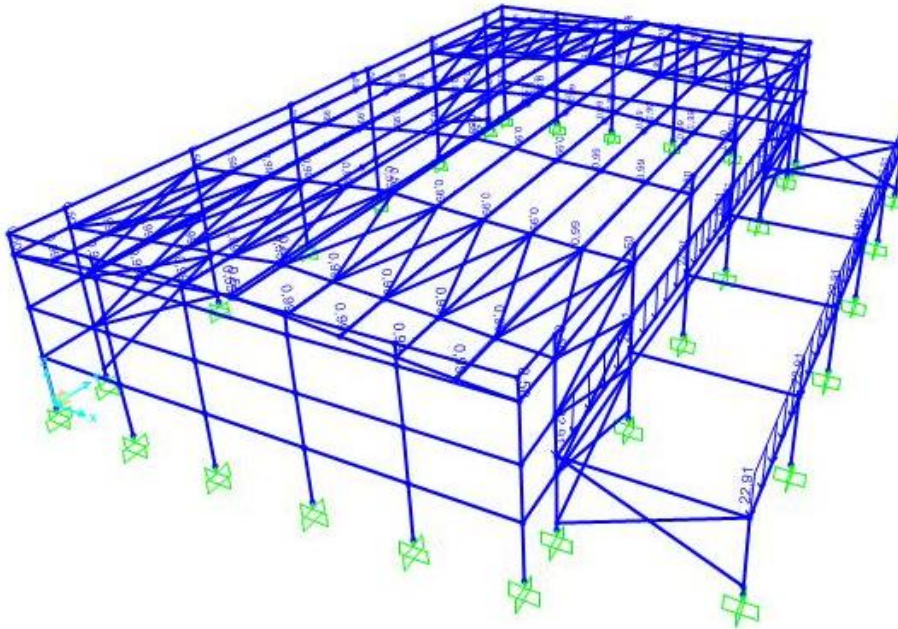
Estructura bajo la acción de la sobrecarga de uso (SAP2000)
